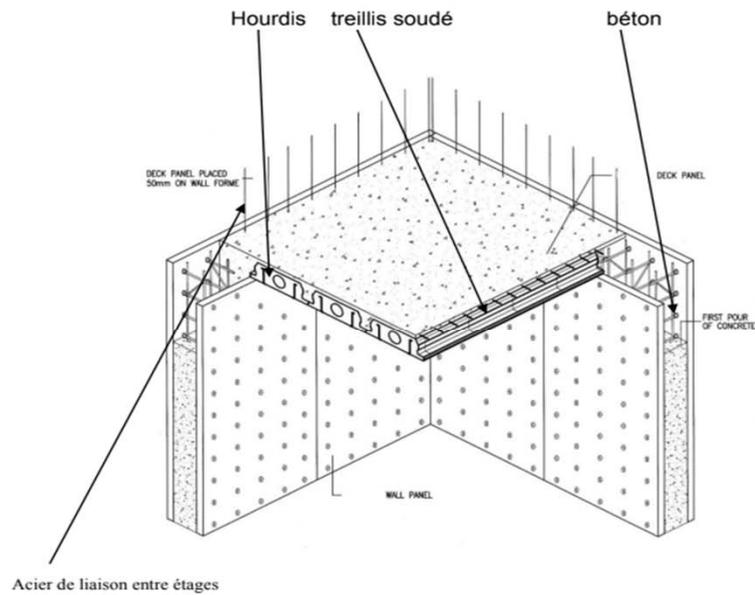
PLASTBAU-3® – Exemple de liaison plancher / mur
